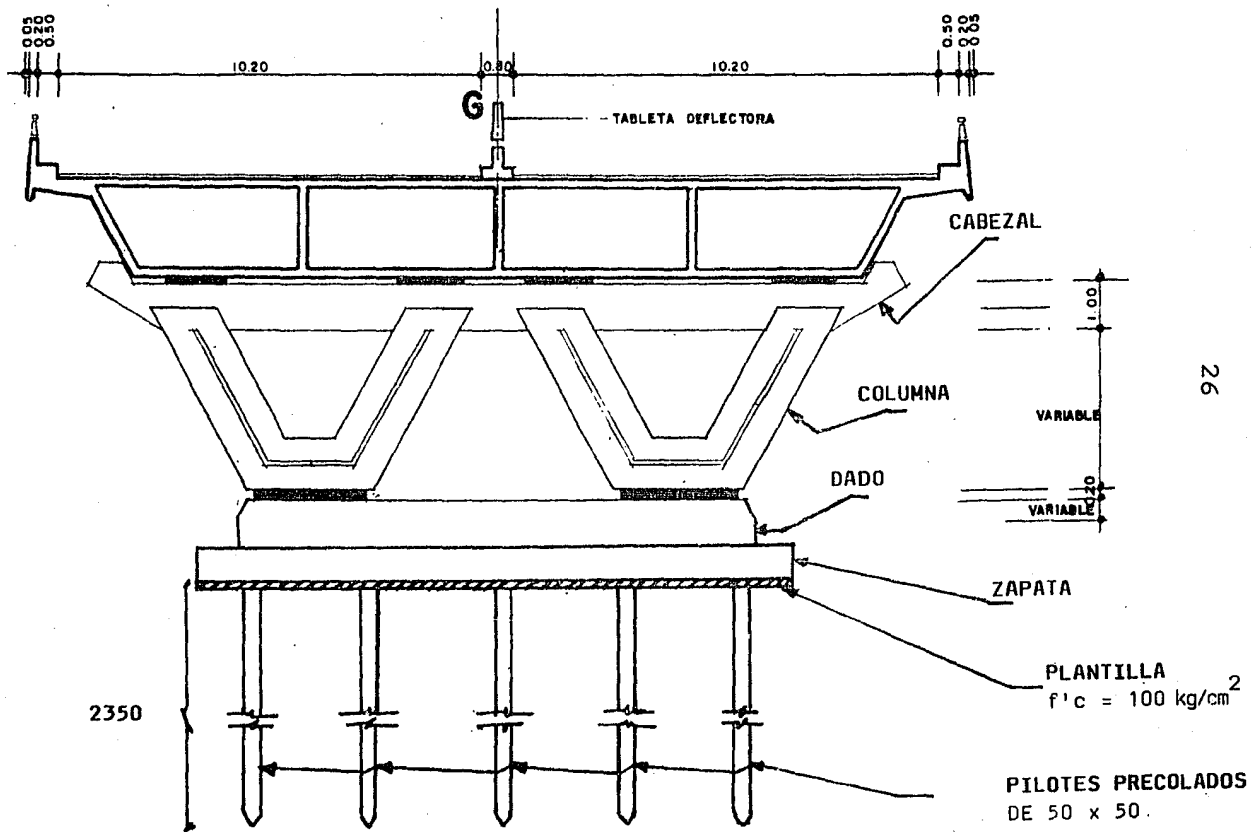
CIMENTACION Y COLUMNAS DE LAS PILAS
